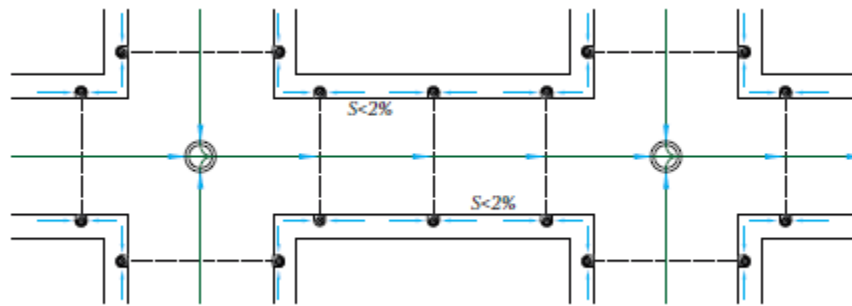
Ubicación de coladeras de banquetta. Fuente: CONAGUA, 2015.
